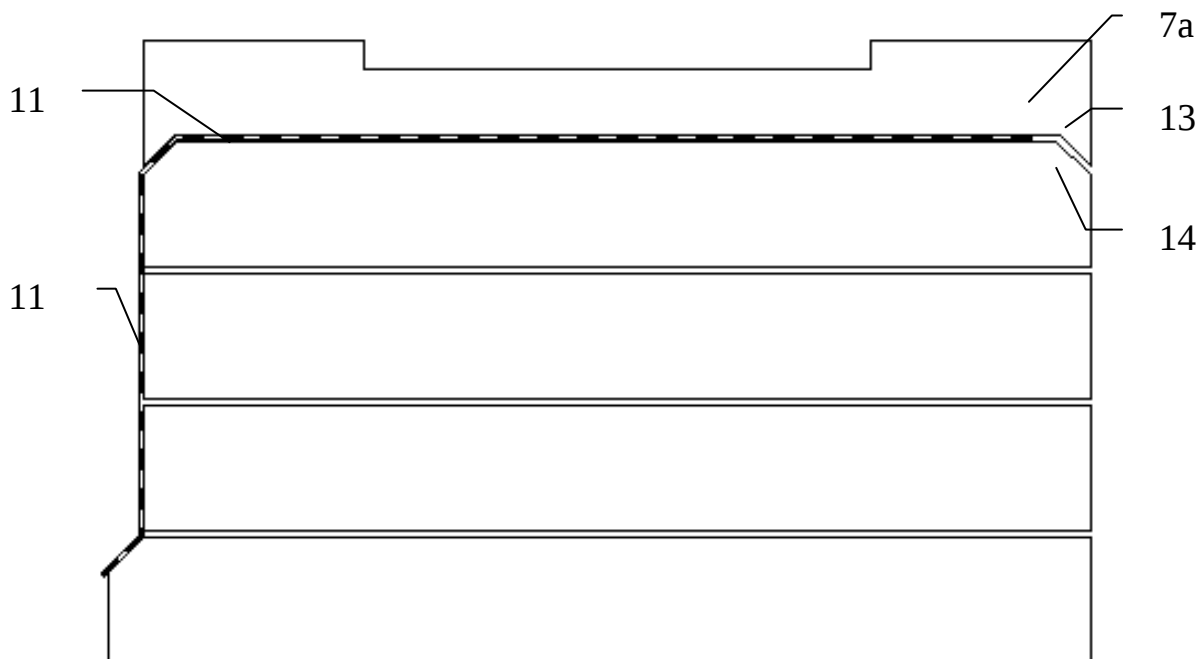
Návrh využití – asfaltový typ [57][58][59]
